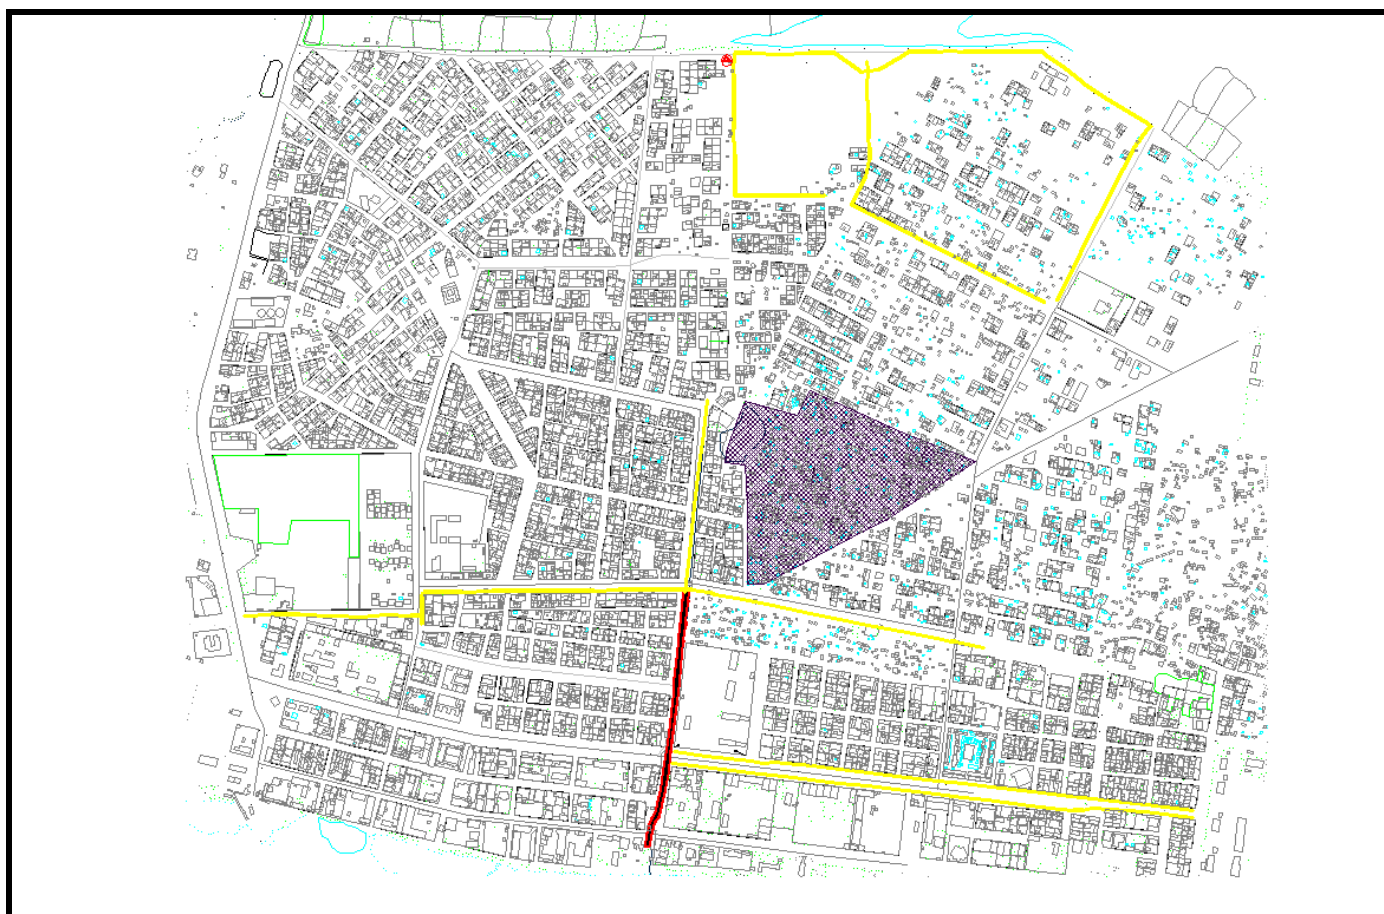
plan du réseau existant des eaux pluviales à Rosso
